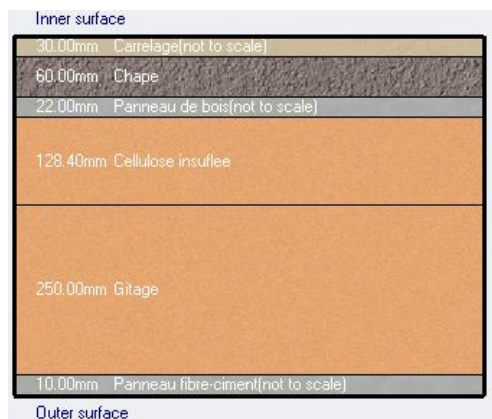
DesignBuilder - Construction – Plancher RDC – Illustration
